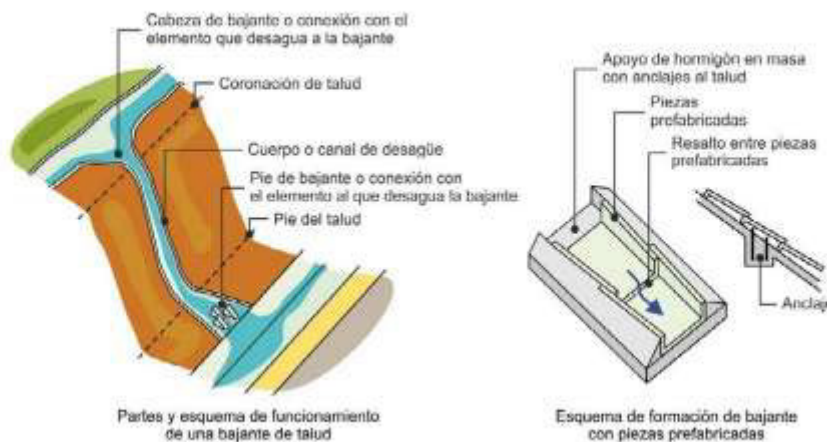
Bajante prefabricado/ Instrucción 5.2.1.C
